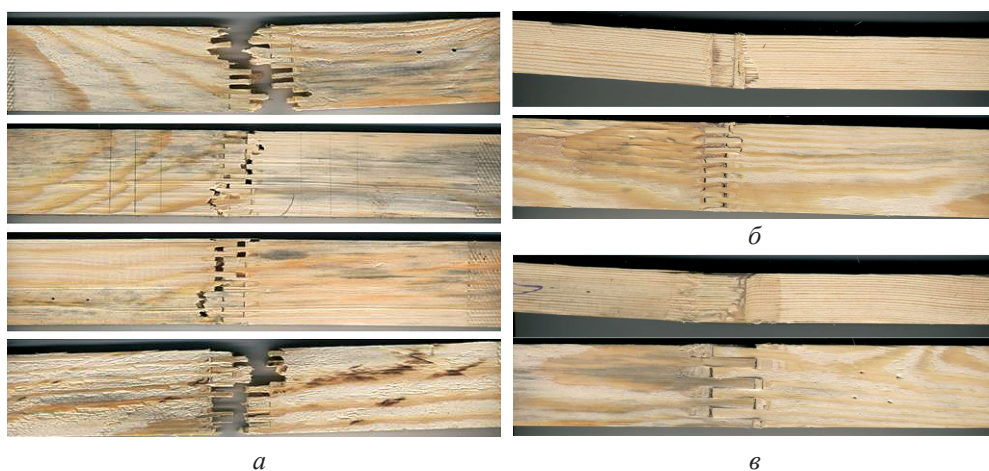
Примеры разрушения образцов двух типоразмеров в результате испытаний на растяжение (*a*) и изгиб (*б*, *в*): *a*, *б* – типоразмер А; *в* – типоразмер Б (вид сбоку и сверху)
